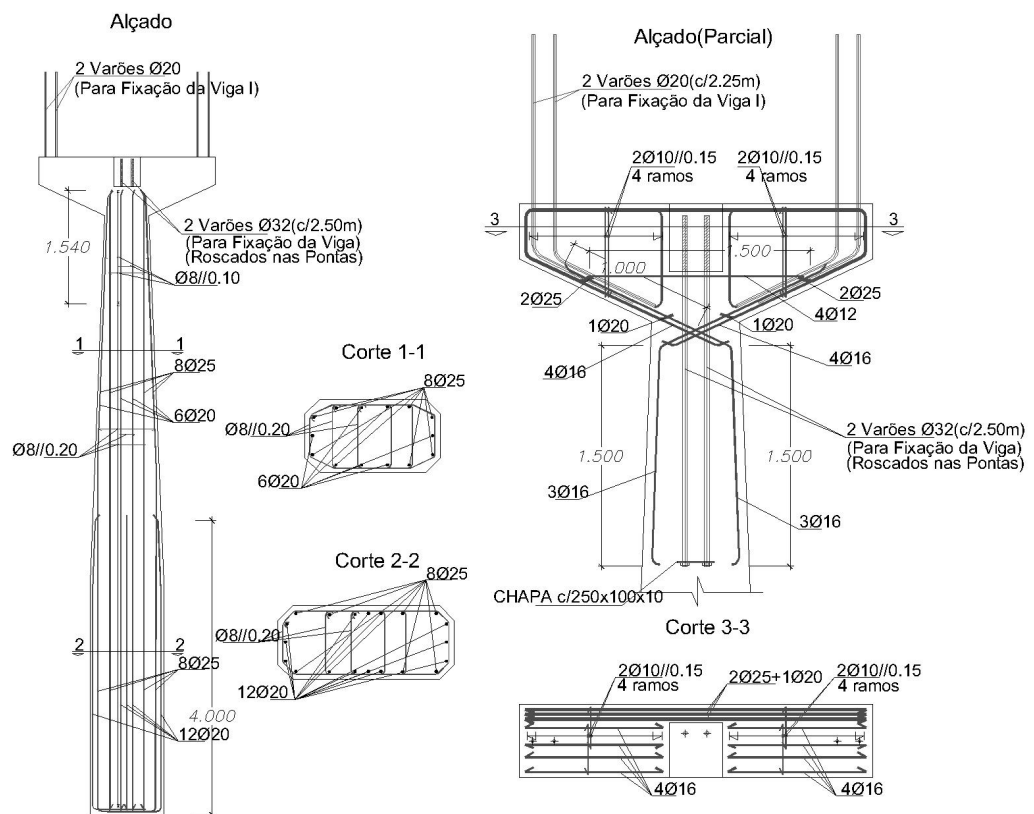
Pormenorização de armaduras dos pilares [18]
